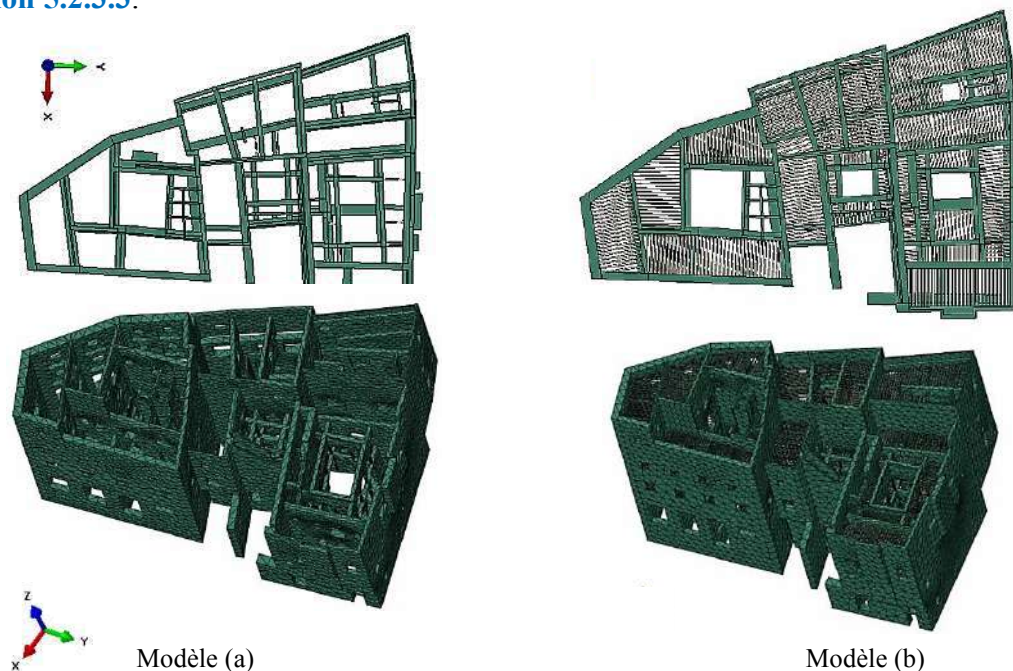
Modèles par éléments Finis : 1) planchers flexibles (Modèle a) ; 2) planchers rigides (Modèle b)
